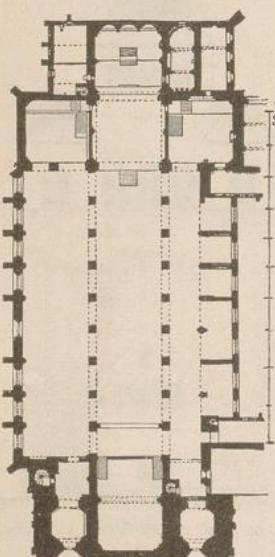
Grundriss des Doms zu Bremen.
